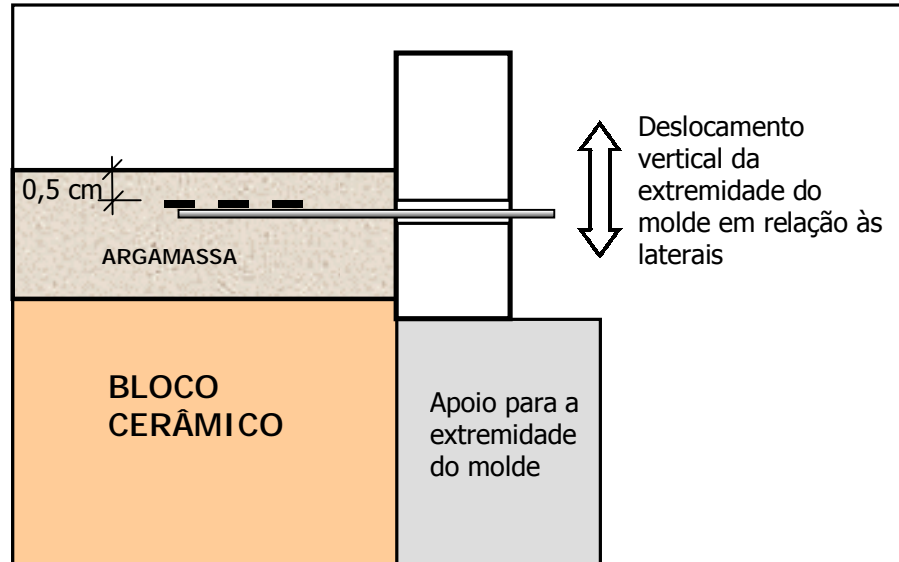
Molde posicionado sobre bloco cerâmico para realização de ensaio de retração em argamassa de 25 mm de espessura, com grelha metálica posicionada a 5 mm da face superior da camada – desenho esquemático (vista parcial de corte longitudinal).
